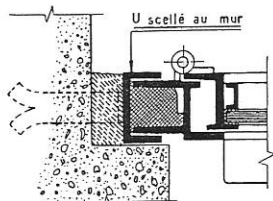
Détail de fixation d'un châssis au droit d'un joint de dilatation.
